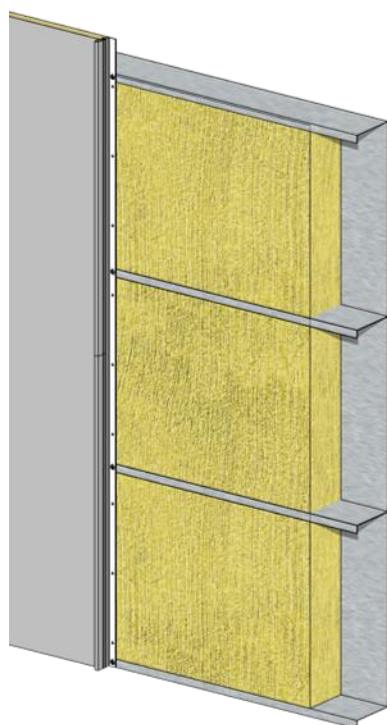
Principe d'emboîtement du profil joint debout MYRAL
